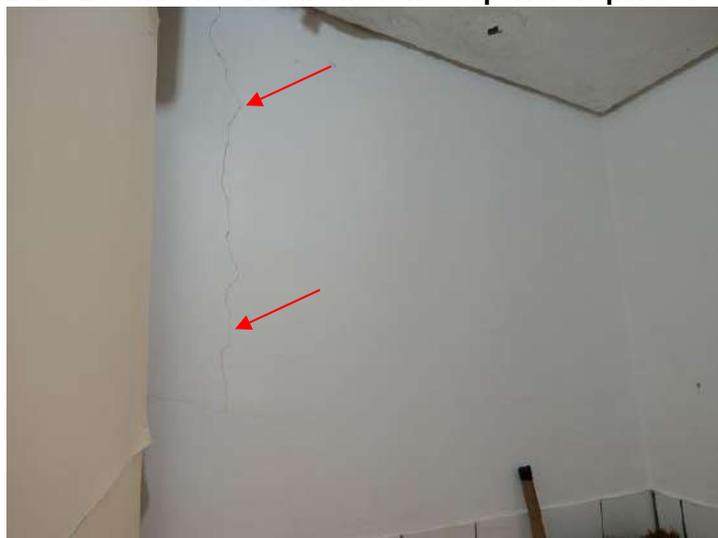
Lavanderia – Fissuras na parede interna
